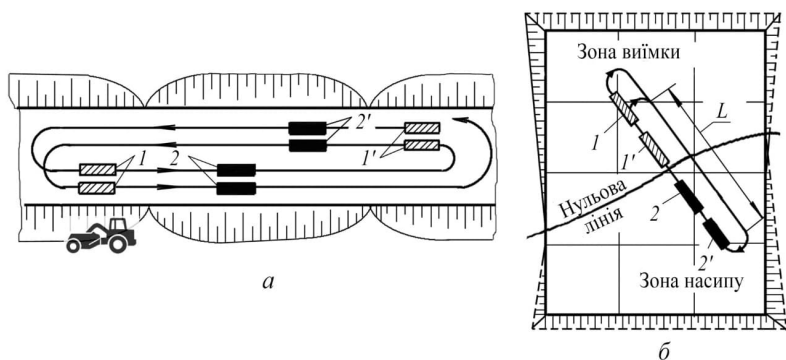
Планування площадок скреперами: *а* – схема роботи скрепера «за спіраллю» на ділянці з насипами і виїмками, що чергуються; *б* – те ж саме, «за еліпсом» при плануванні площадки; 1, 1' – набір ґрунту; 2, 2' – розвантаження ґрунту
